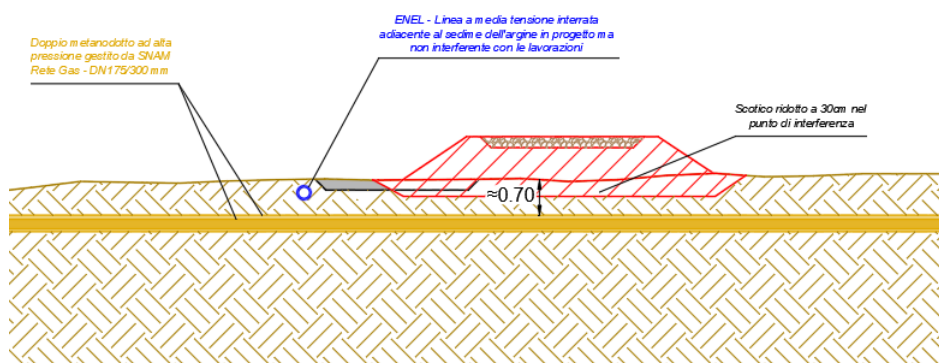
UBICAZIONE DELLA LINEA ELETTRICA MT RISPETTO ALLE OPERE IN PROGETTO - VISTA IN SEZIONE
